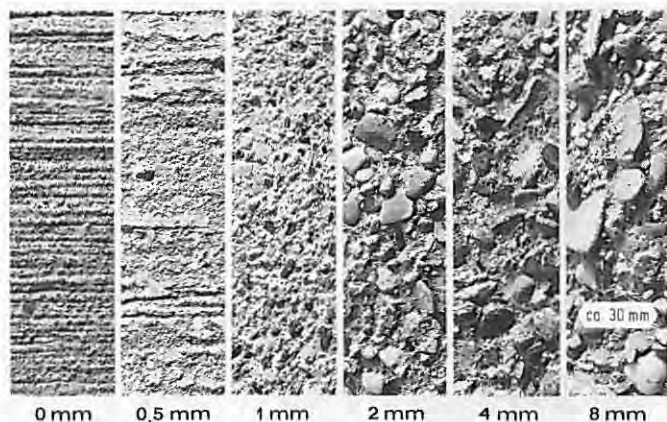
Oberflächen eines Betons mit 32 mm Größtkorn bei mittleren Abtragsdicken von 0—8 mm.
